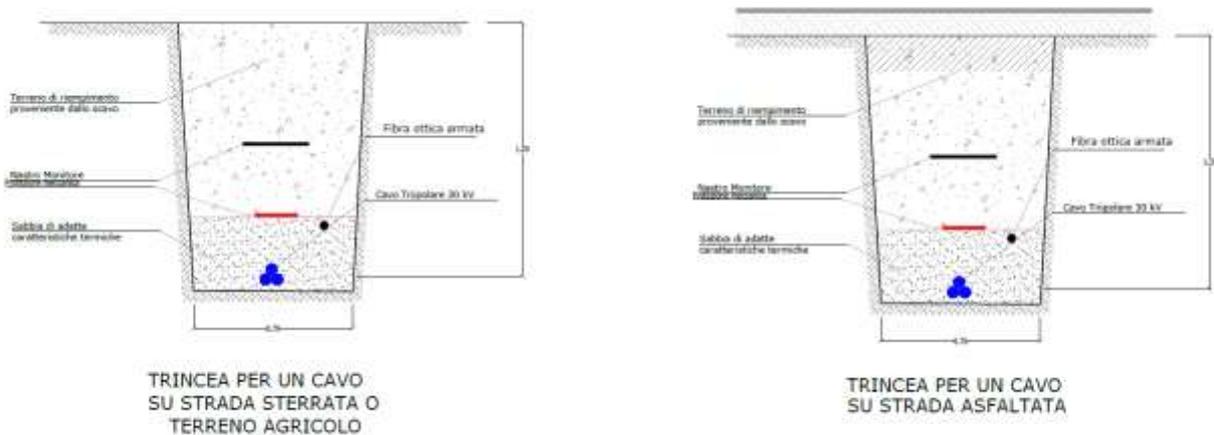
Sezione della trincea di scavo per la posa di n. 1 cavi da 30kV di collegamento dall'impianto FV alla Stazione di Elevazione – su strada sterrata o terreno agricolo e su strada asfaltata
